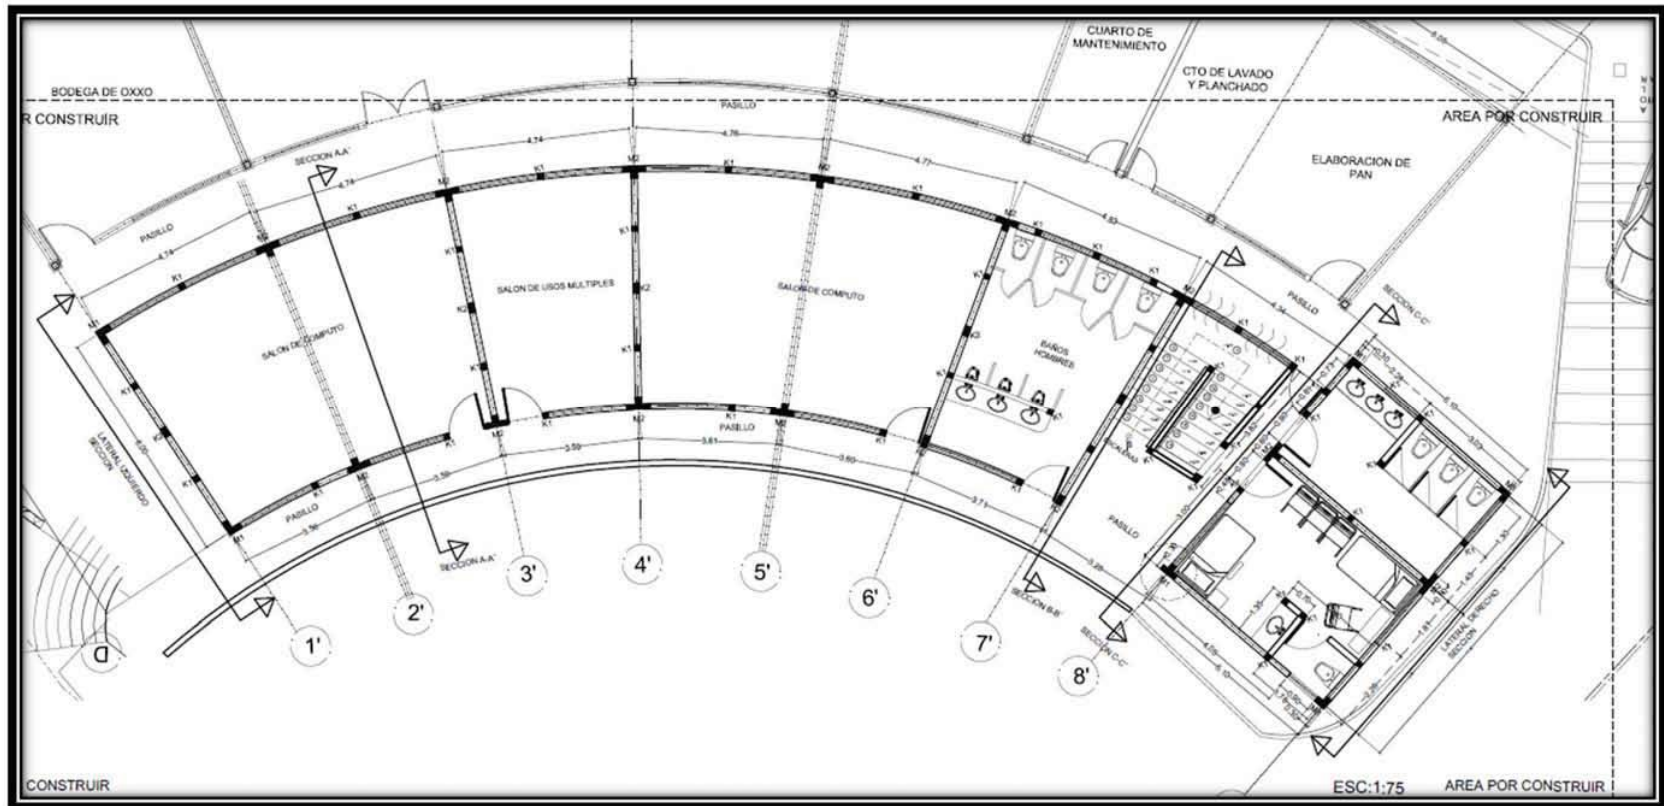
Planta arquitectónica del proyecto en construcción EDIFICIO-4. Plano de planta baja del edificio.
